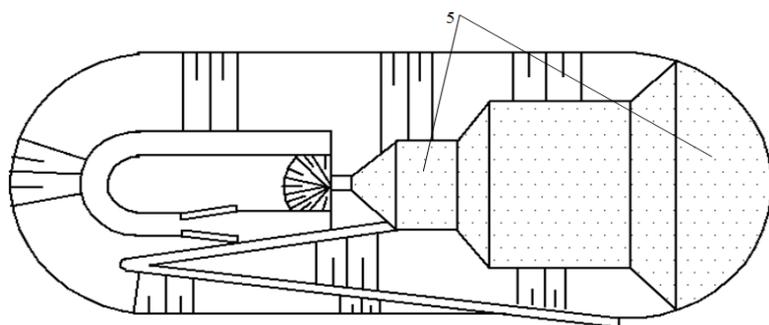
План карьера на момент его доработки и формирования внутреннего отвала
